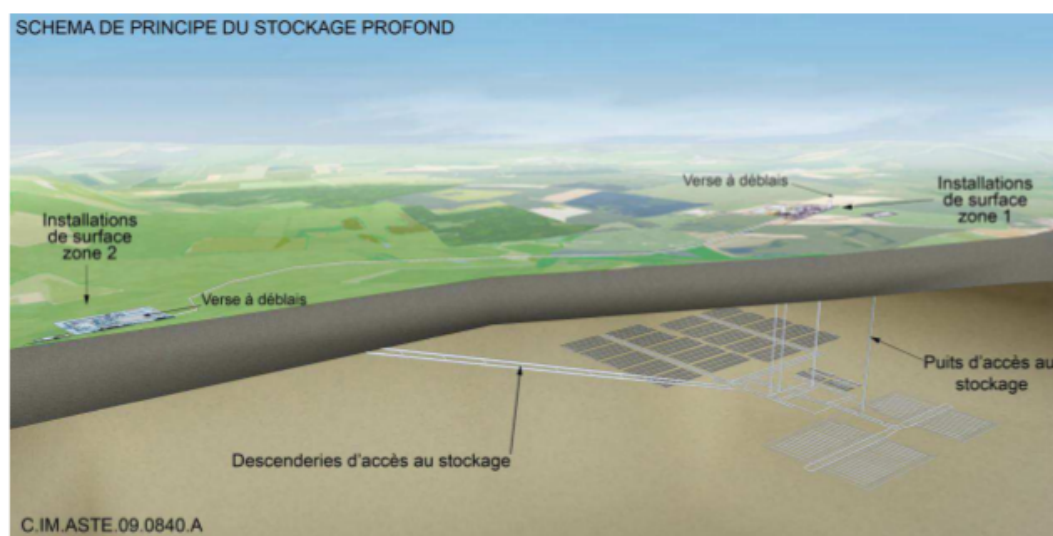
Schéma de principe d'une architecture de stockage (ANDRA, dossier 2009)
